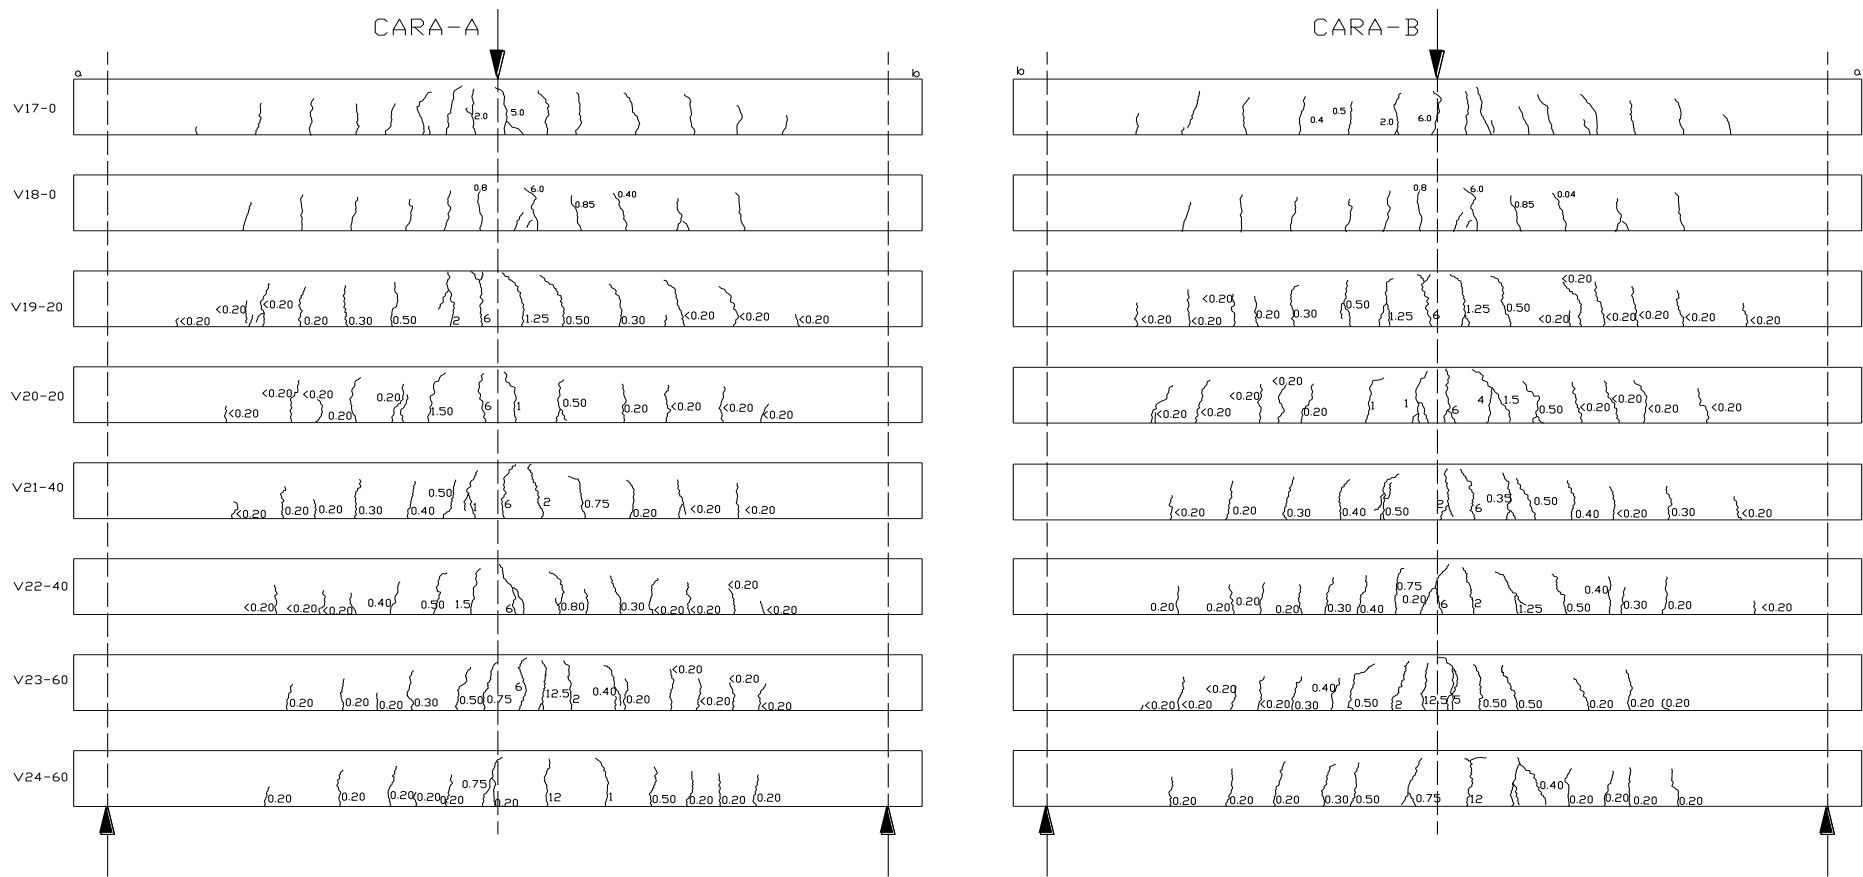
Patrón de agrietamiento en ambas caras de las vigas, $a/cm = 0.60$, edad de 12 semanas. Los valores sobre las grietas representan el ancho de grieta, en mm.
